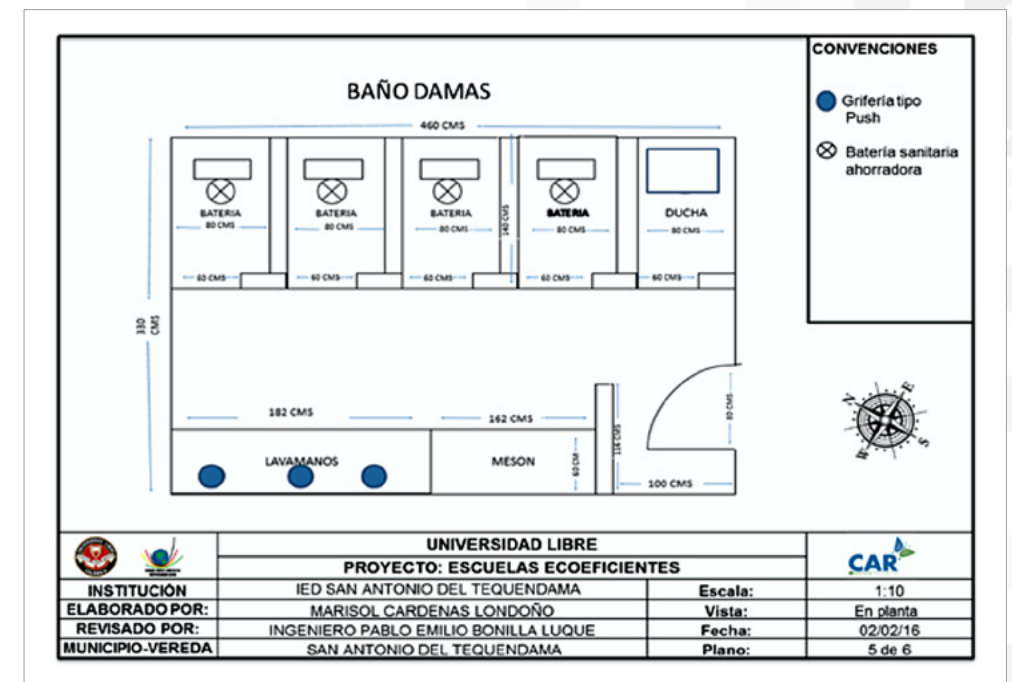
Vista de los baños de damas, instalación de baterías sanitarias y grifería ahorradora
